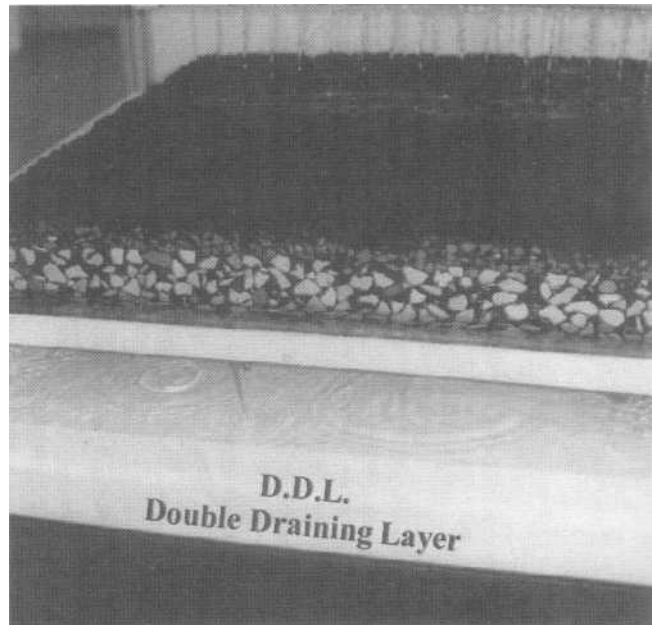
Sezione di pavimentazione a doppio strato drenante
